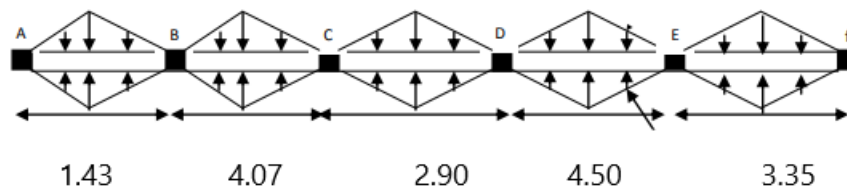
Distribution des charges sur les poutres secondaires
